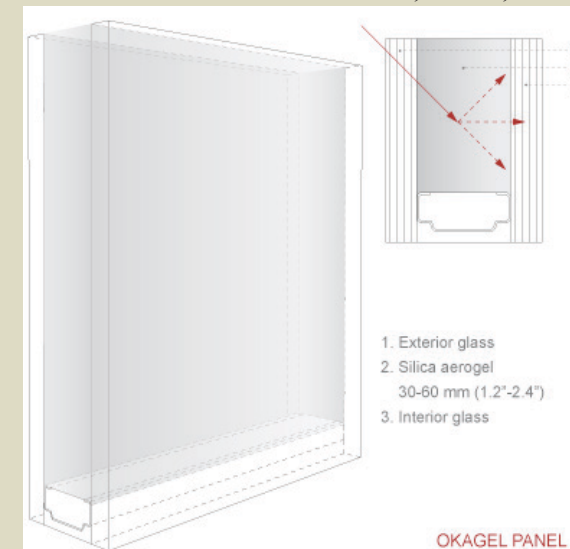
Fassadenelement OKAGEL, planzeicherische Darstellung, Axonometrie, Schnitt
